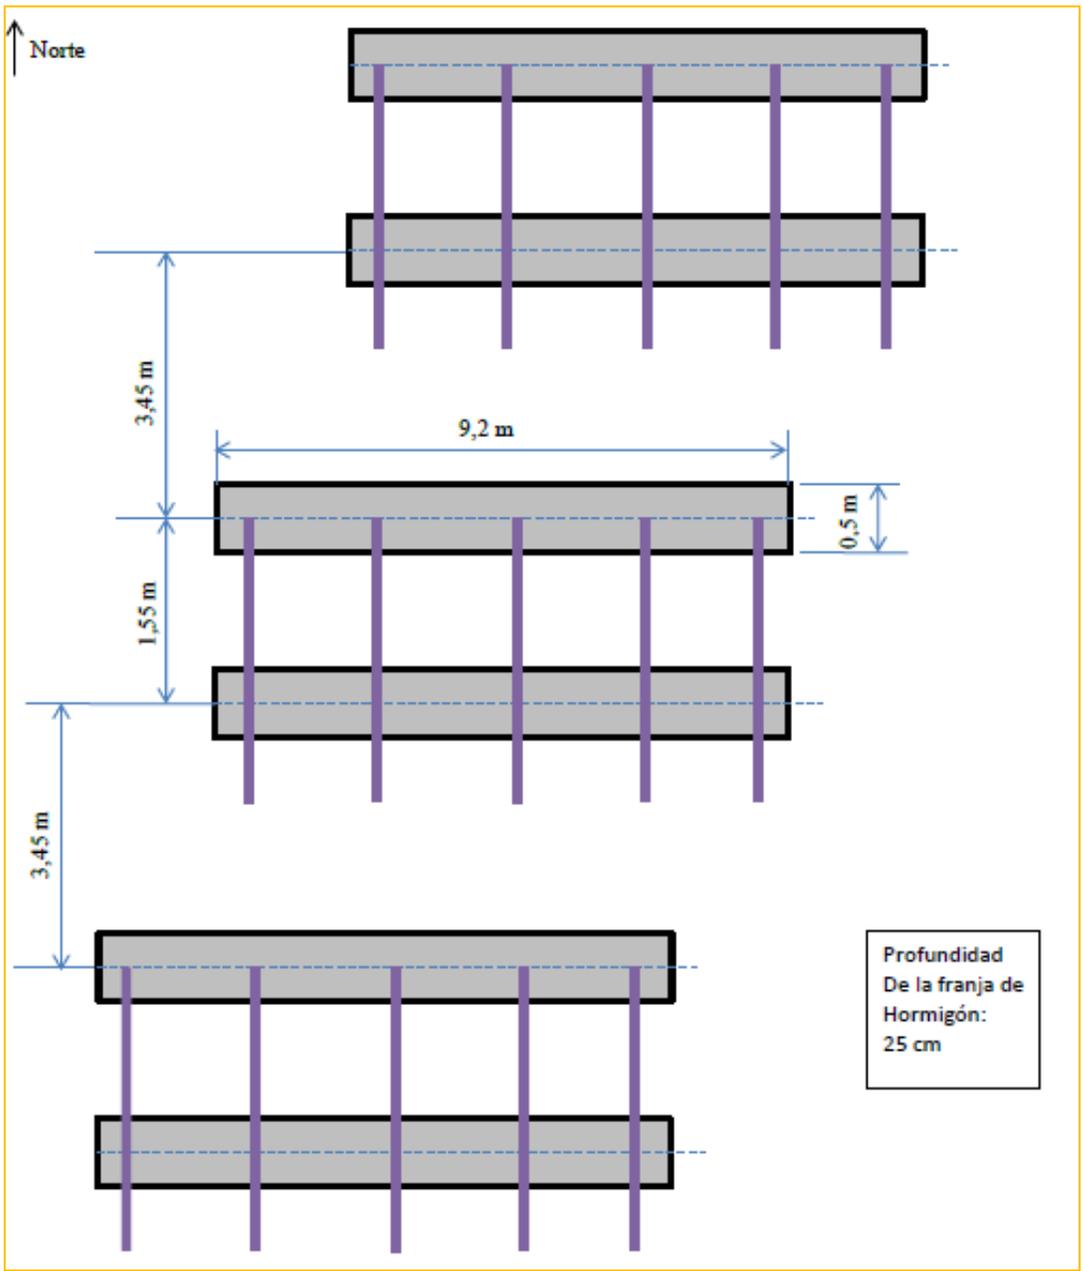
Tamaño e ubicación Zanjas de Hormigón
